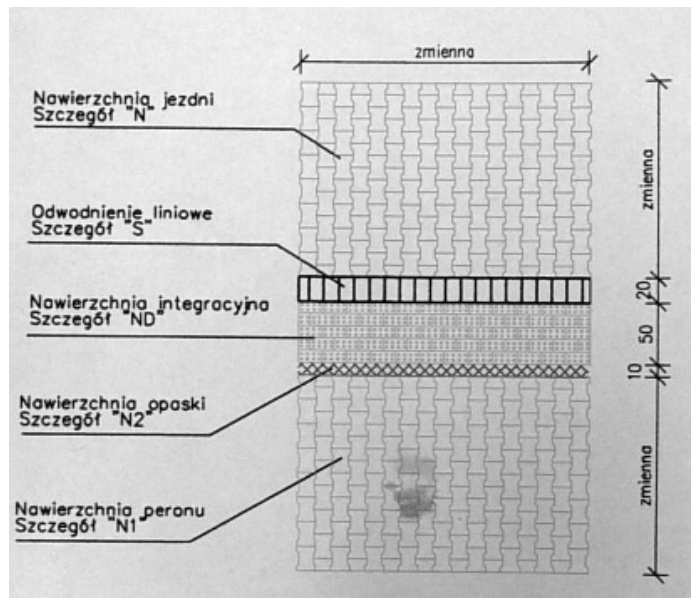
Projekt budowy przystanku wiedeńskiego (przekrój poprzeczny)
